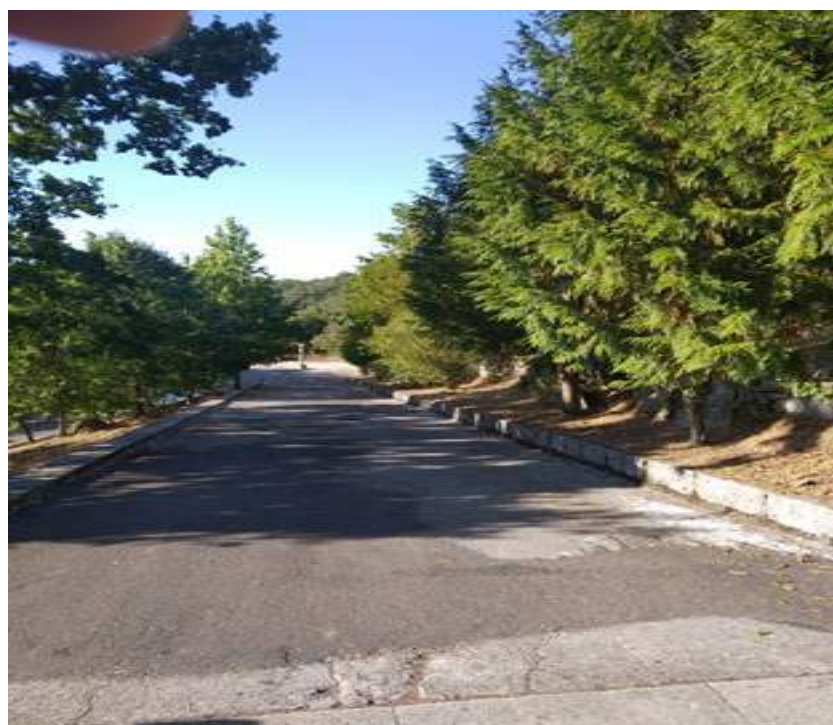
Inicio de la carretera de acceso al monasterio.
